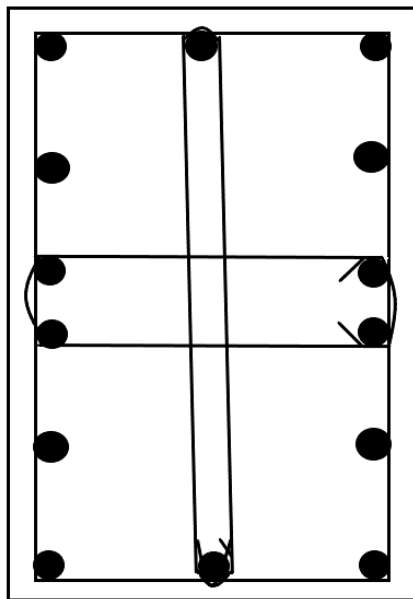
coupe transversale de ferrailage de l'entretoise d'about
